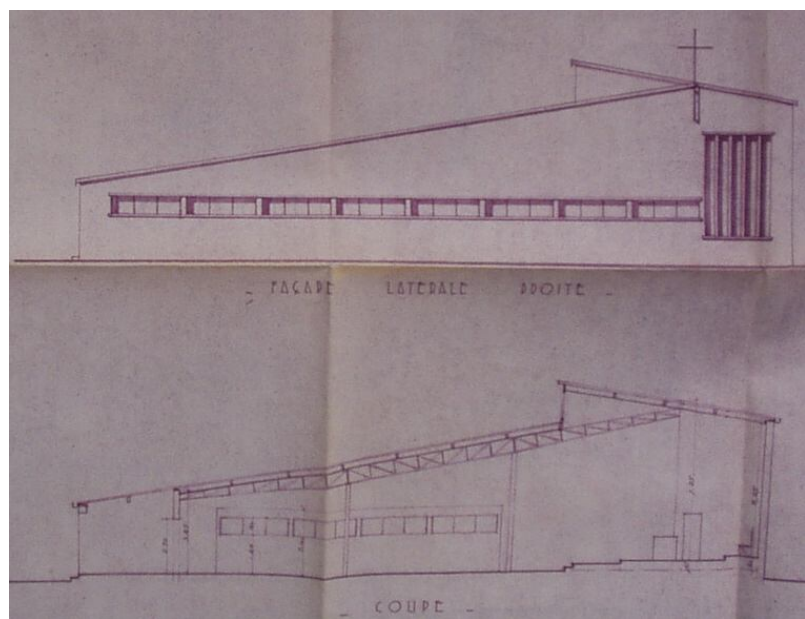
Variante du projet [s.d.], coupe longitudinale et façade latérale (AD Cambrai 7 L 2.85)
